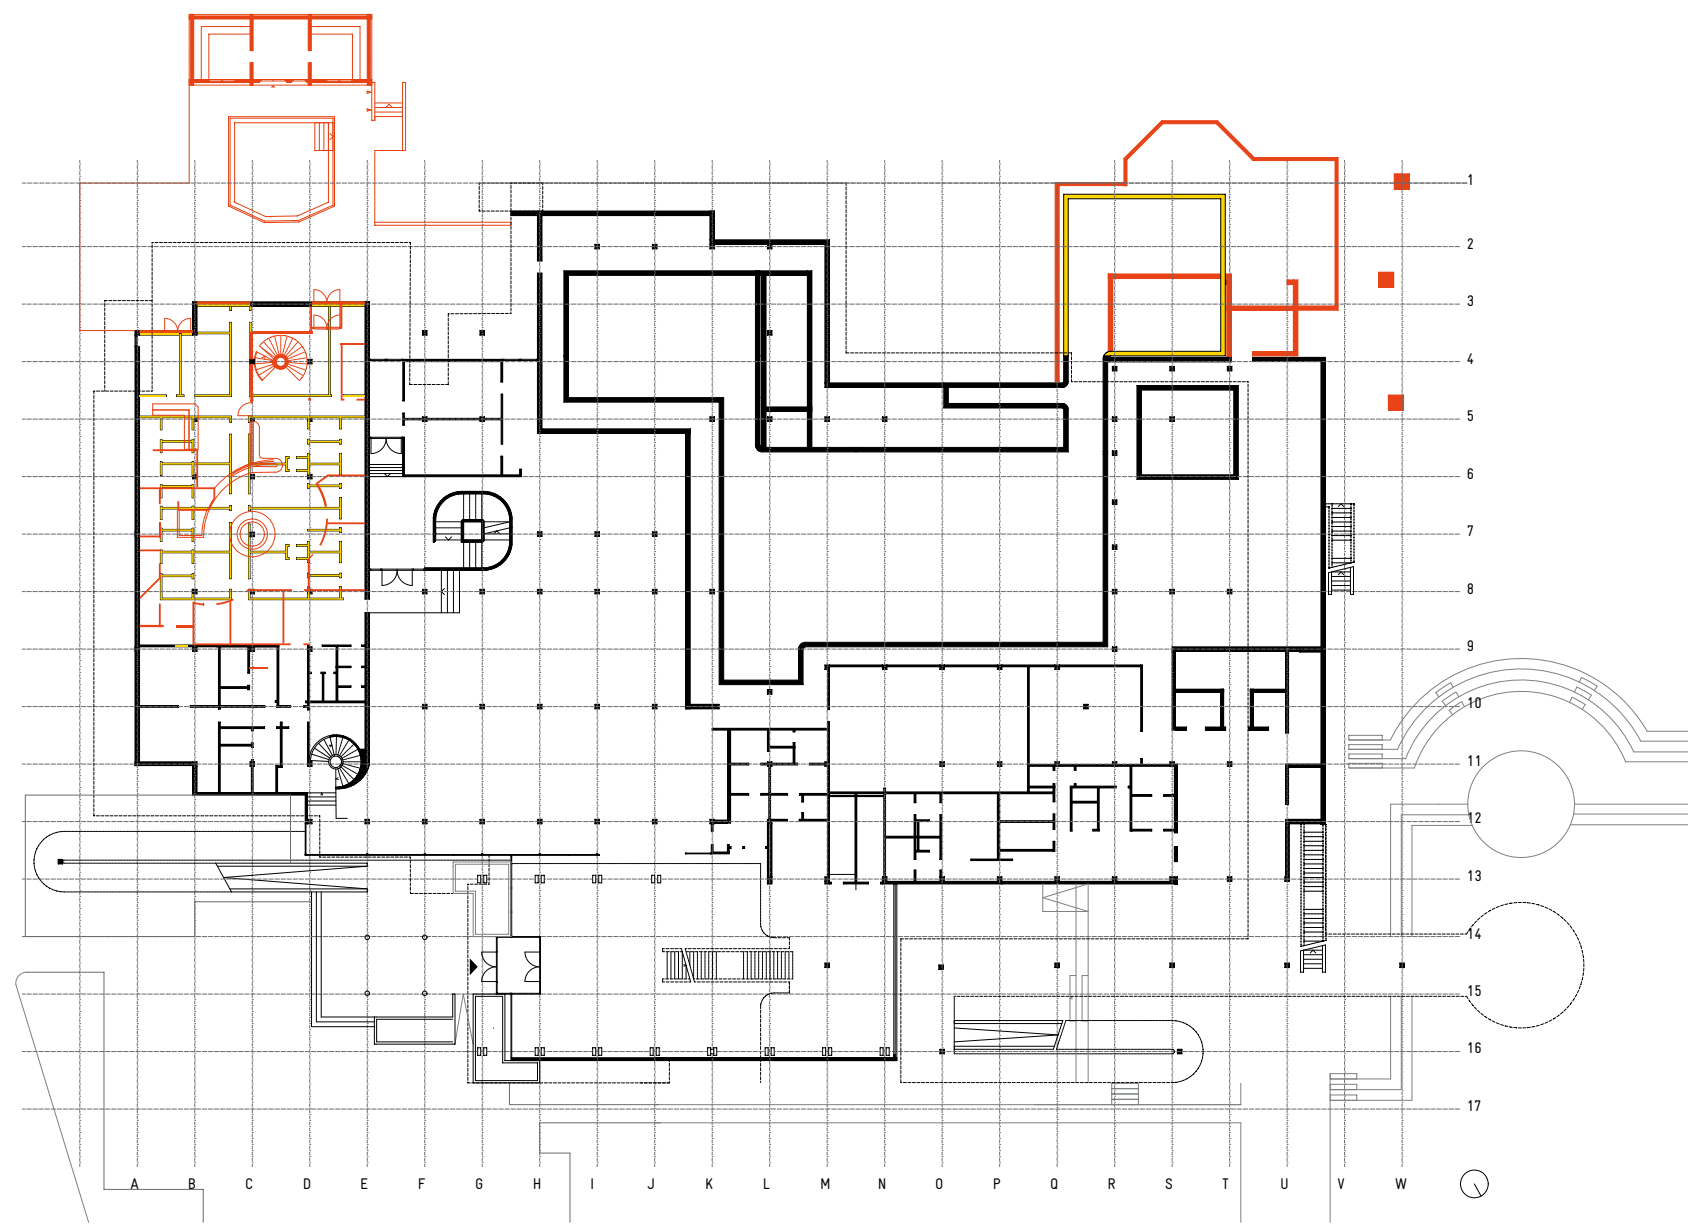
Grundriss Erdgeschoß inkl. Umbau Saunatrakt und Freibereich
